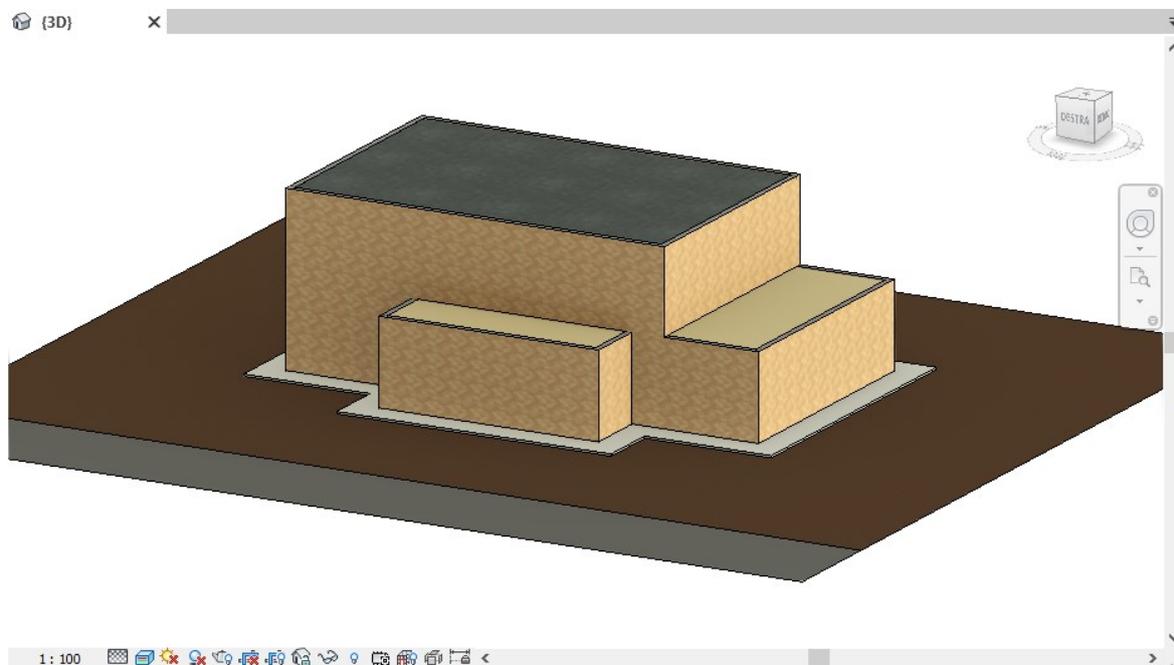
Vista tridimensionale pavimenti e muri (3D): Modello architettonico
